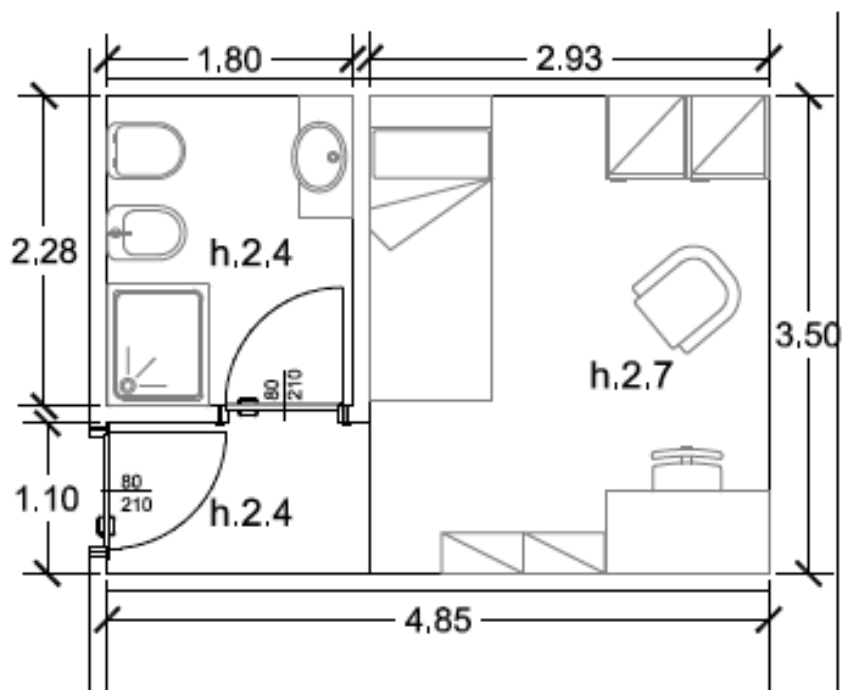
3 - Pianta tipo alloggio in camera singola - Fonte: elaborazione dell'autore
